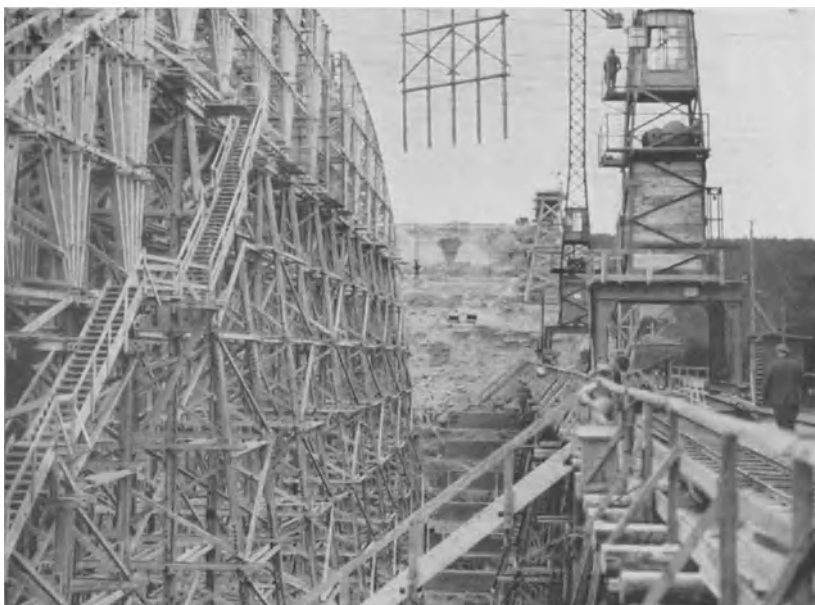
Das Lehrgerüst im Bau. (Turmdrehkrane von 28 m Nutzhöhe und 20 m Ausladung.)
